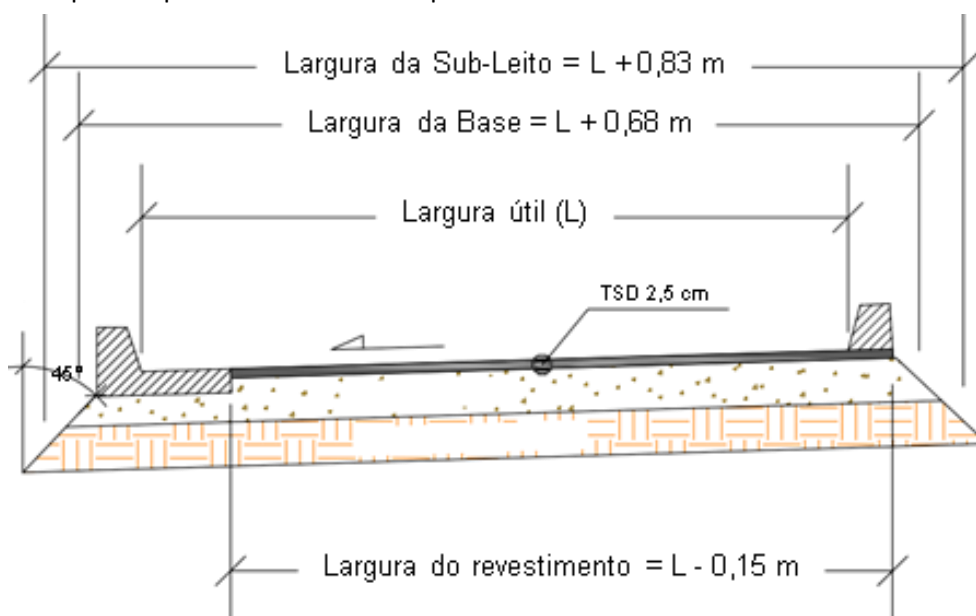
Larguras das camadas do pavimento para caimento simples (Tráfego Muito Leve)
